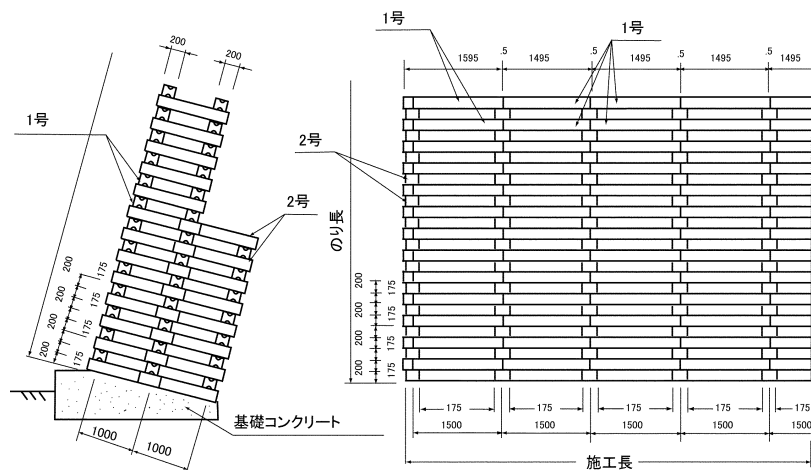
井桁組擁壁工の一例 (単位: mm)
